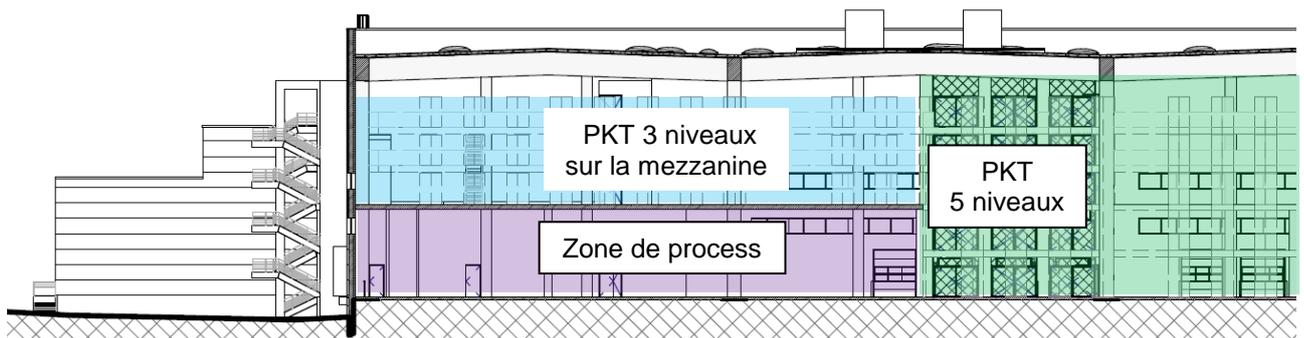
Coupe dans l'entrepôt au niveau de la mezzanine
